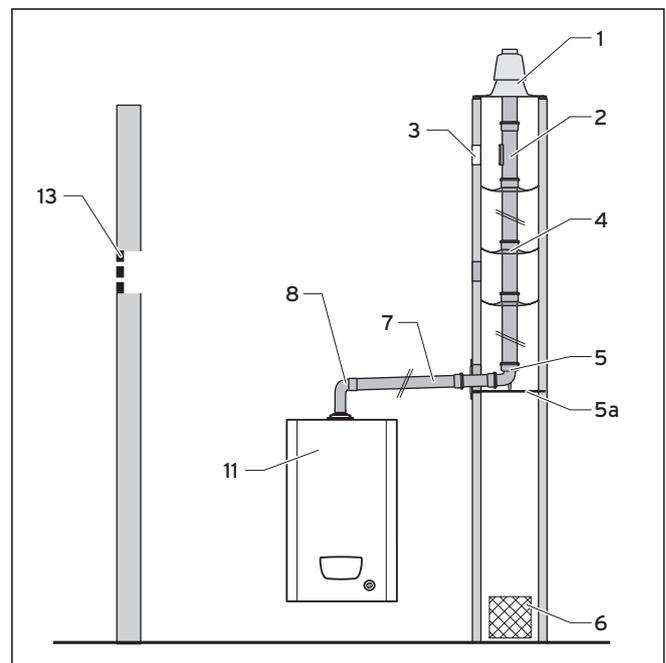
Montaggio del condotto di alimentazione di aria comburente dal locale d'installazione
